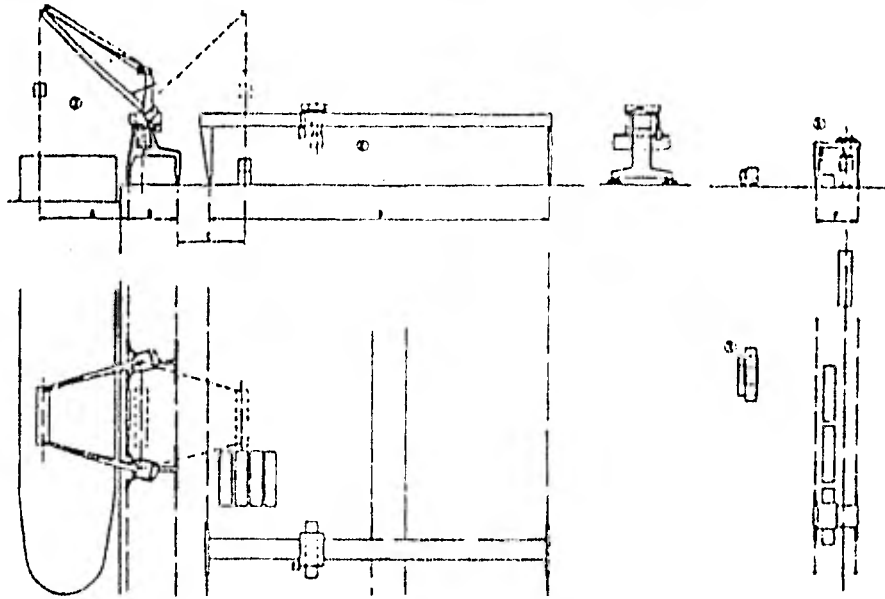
Elevación y planta de un sistema de manejo de contenedores.
